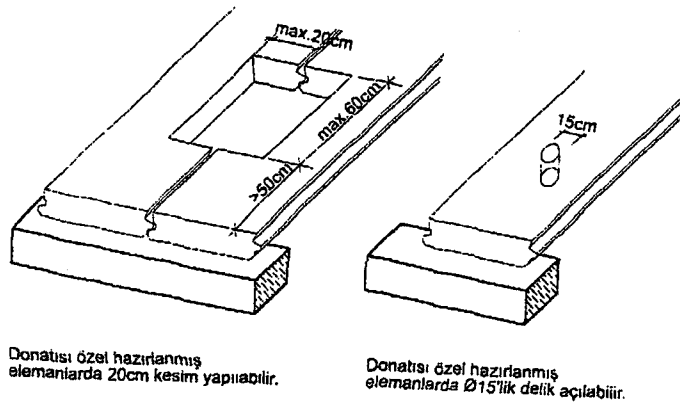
Çatı ve döşeme plağı montaj detayı
